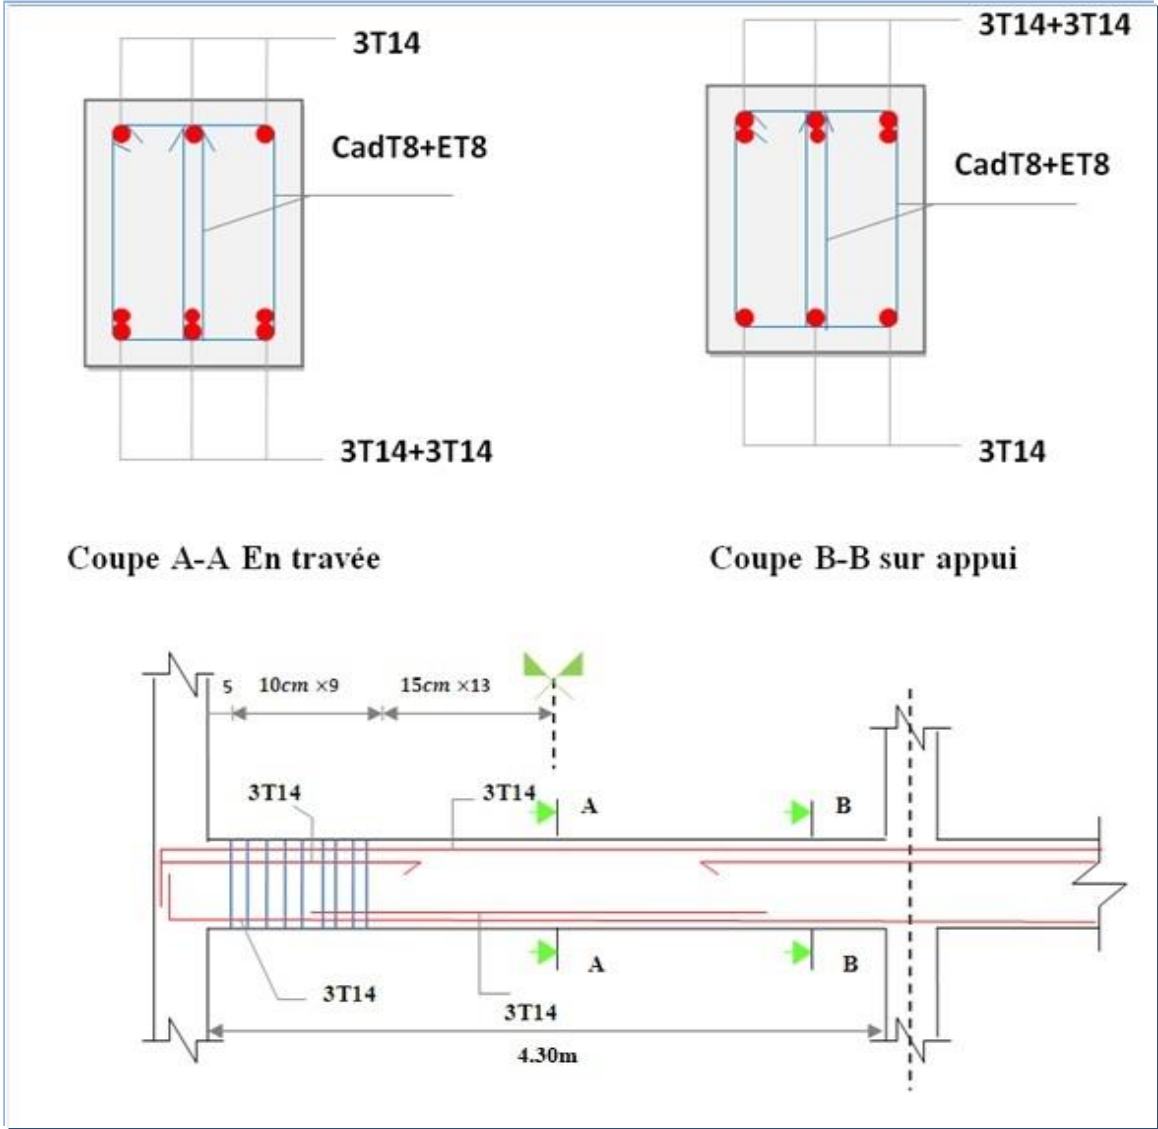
Schéma de ferrailage des poutres 35*45.
